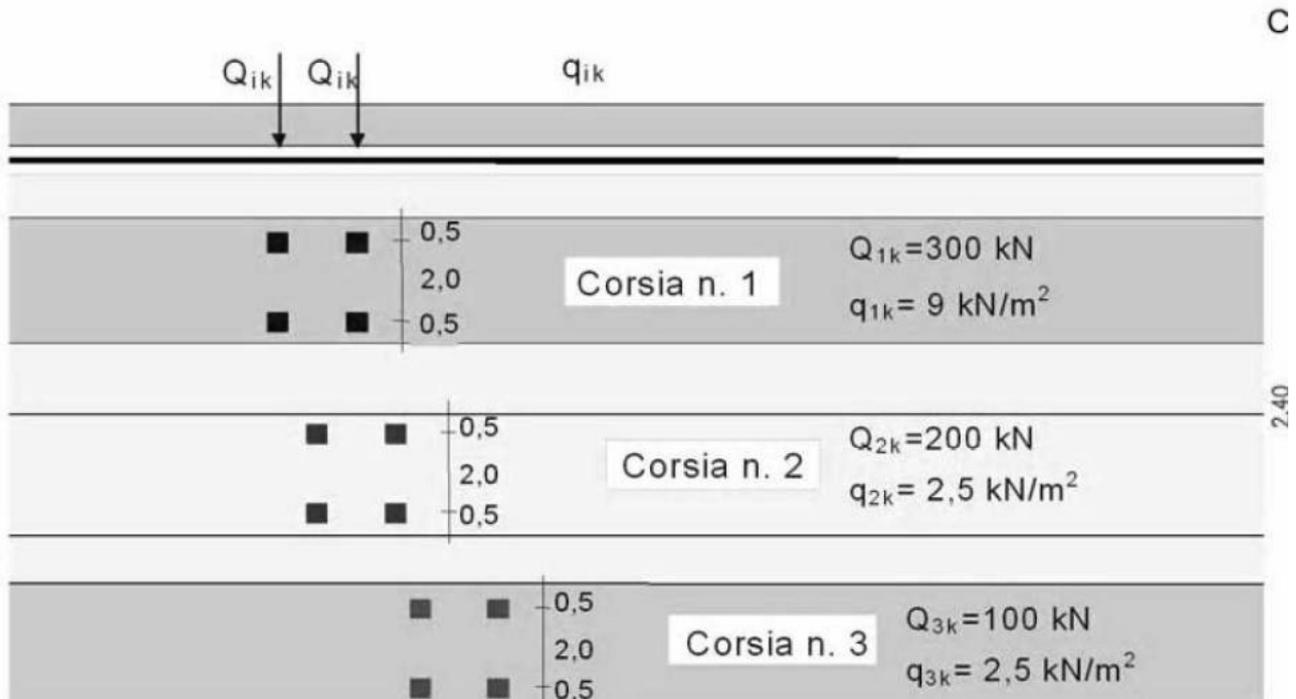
Schema di carico 1 (Fig.5.1.2 delle NTC2018)
